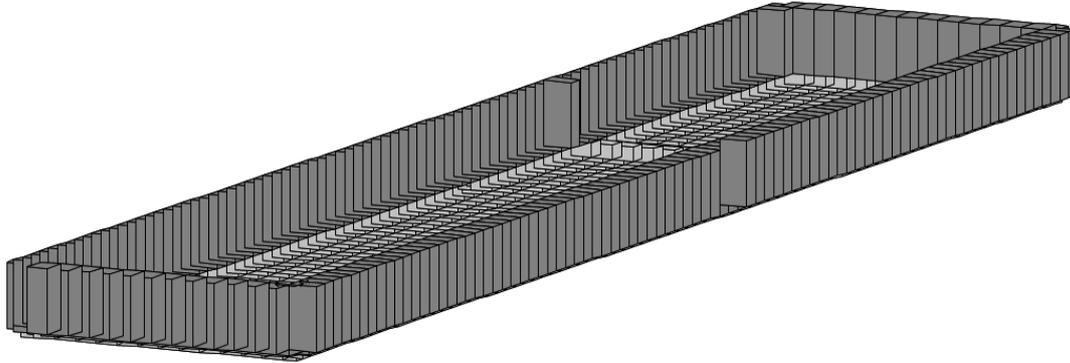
Vista assonometrica del modello di fondazione – elementi estrusi
